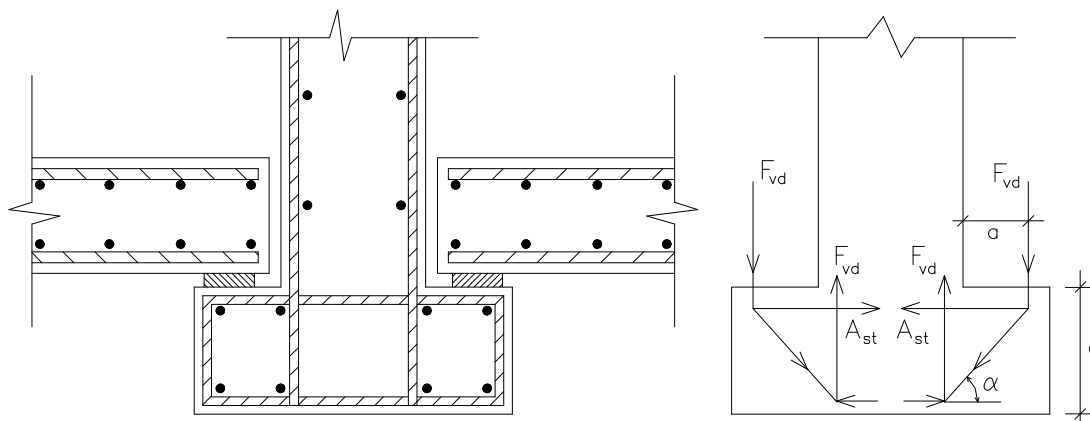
Modelo Resistente da Ligação Viga T Invertida - Laje
